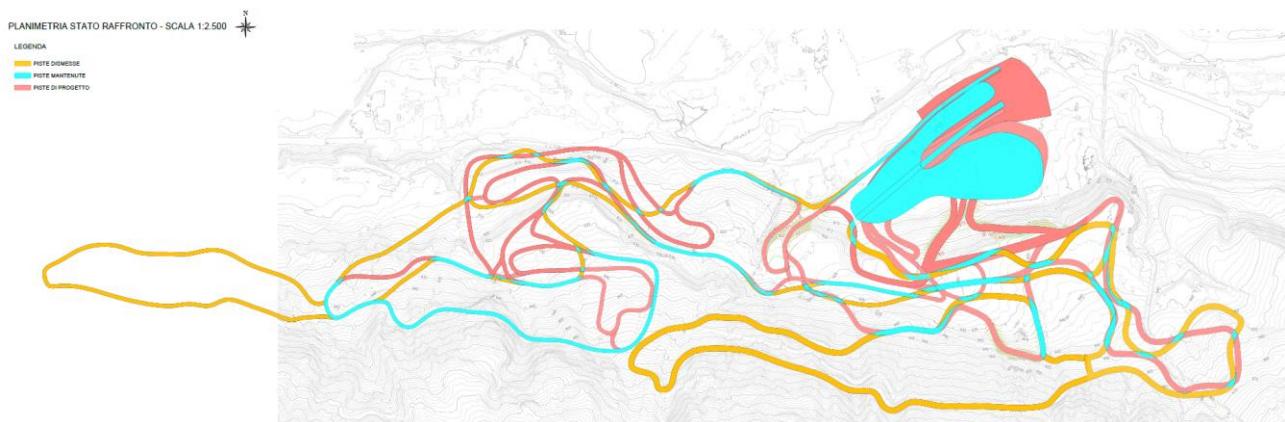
Planimetria di raffronto scala a vista (vedasi tavola E.T.311.002)
